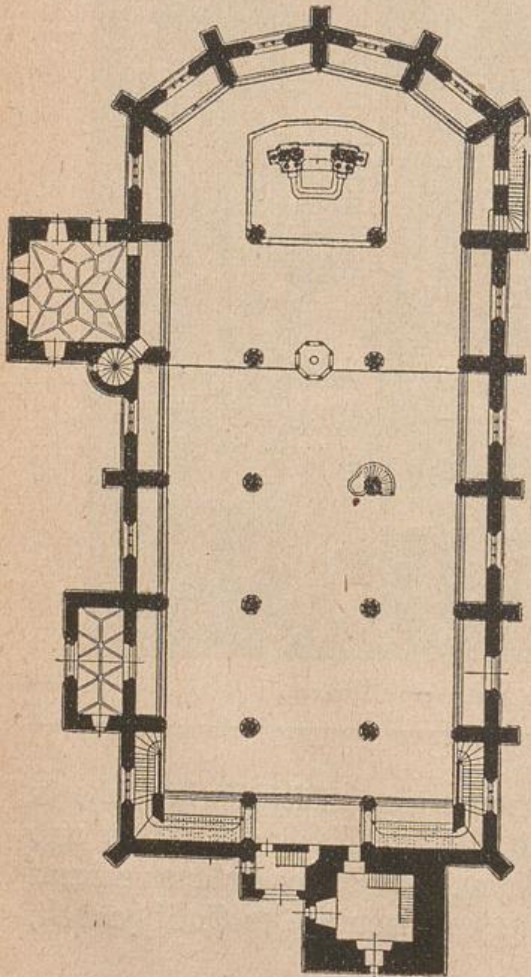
St. Wolfgang in Schneeberg Grundriß.
